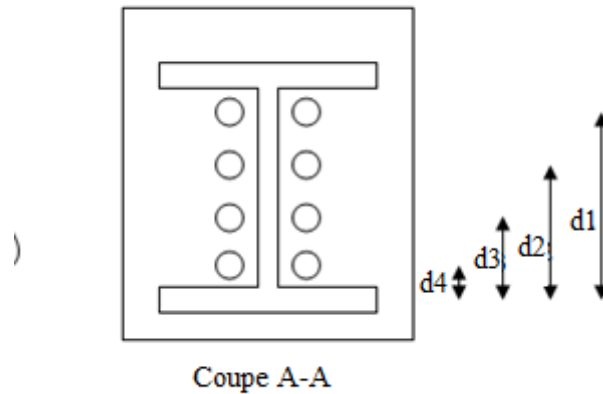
Schémas d'assemblage poutre principale- poteau.
